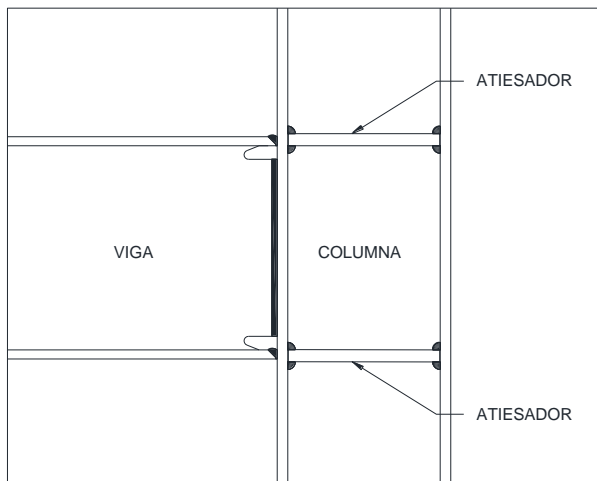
Esquema de conexión viga-columna por soldadura directa.
